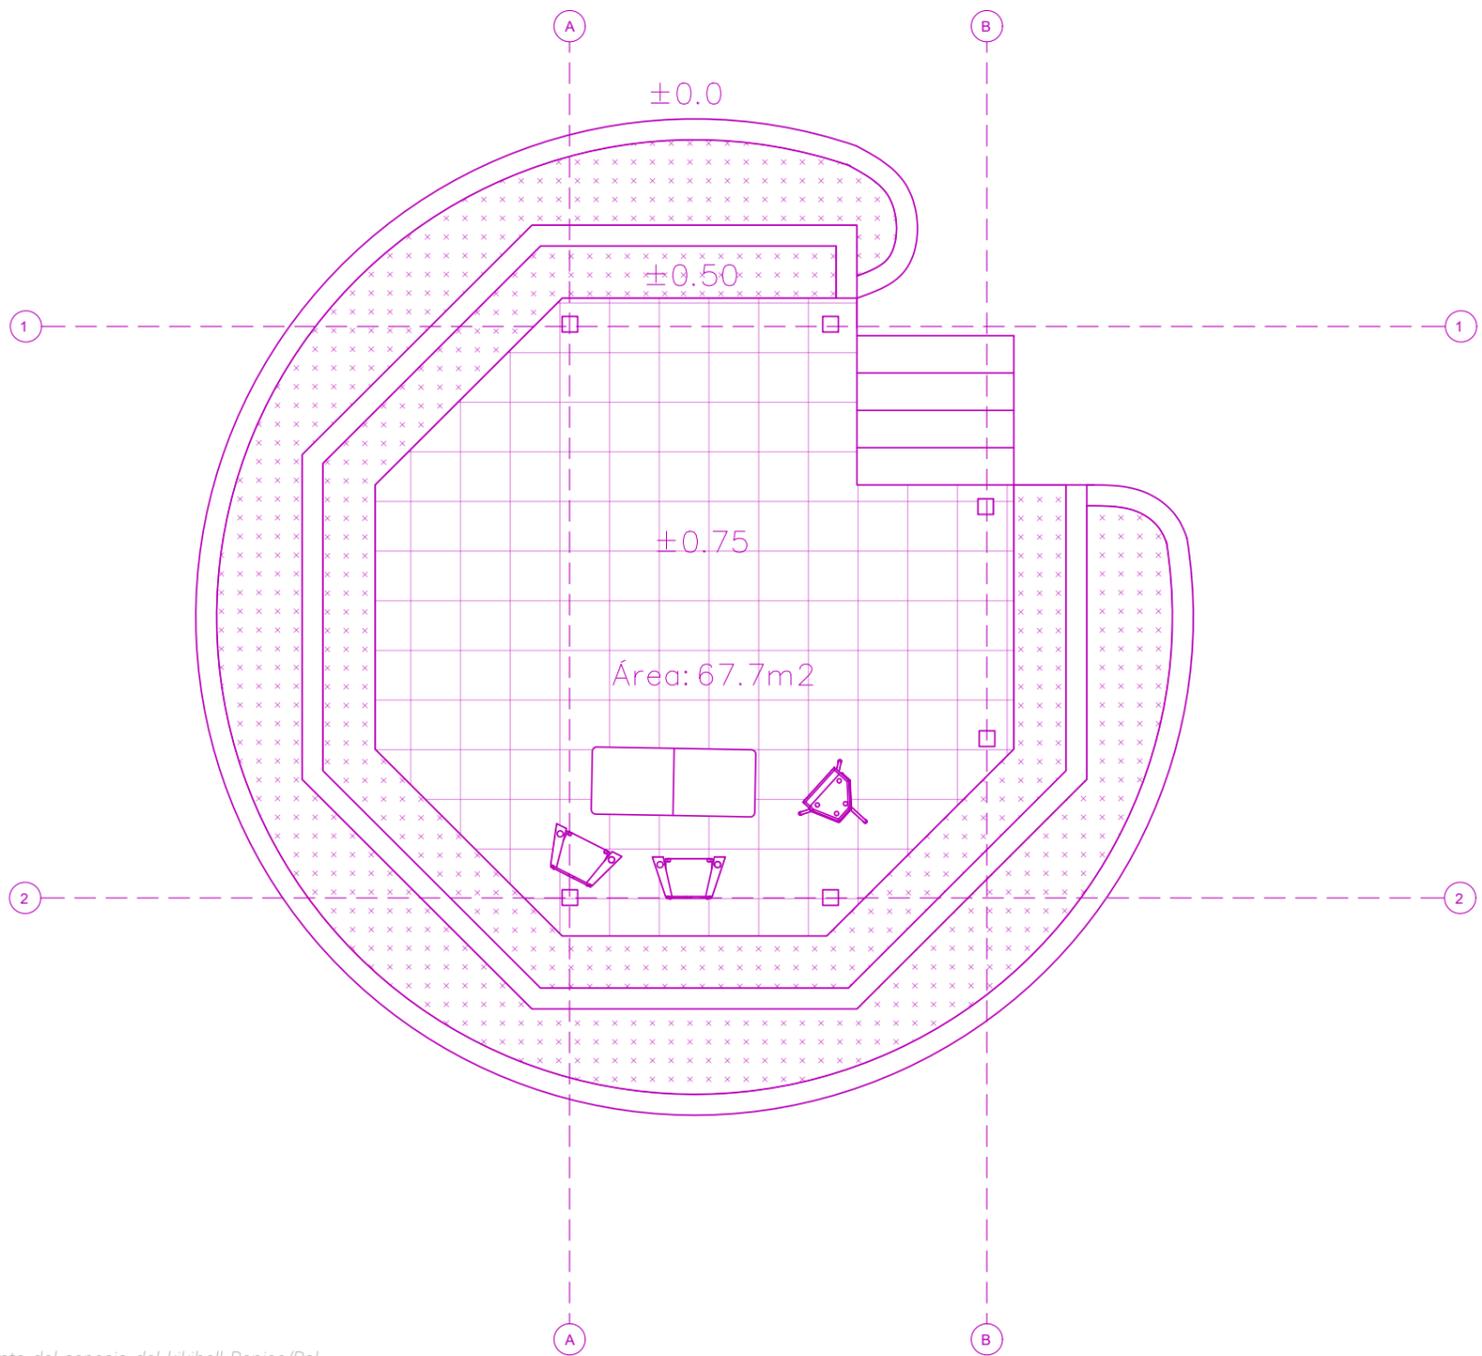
Planta del espacio del kikiball Banjee/Bellakeo. Fuente: Elaboración propia
